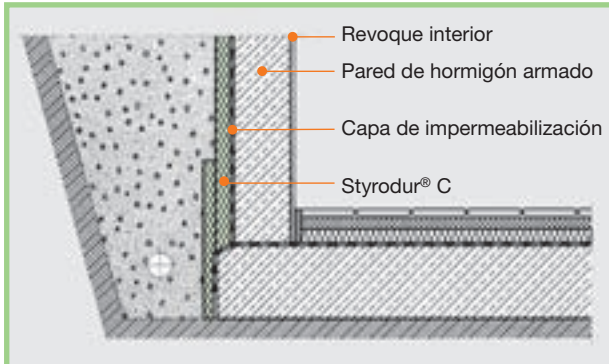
Punto de apoyo del aislamiento perimetral. La plancha de Styrodur® C se apoya en los cimientos.
